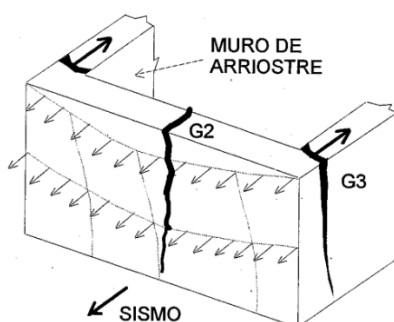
Grietas en los muros por acciones sísmicas perpendiculares al plano.
